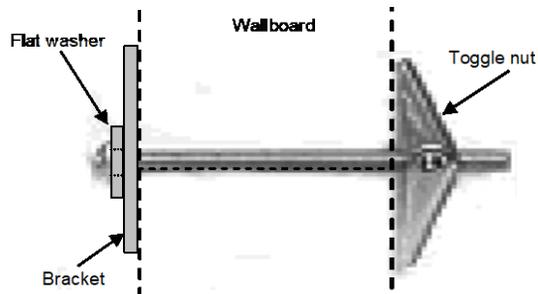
Installation sur panneau de revêtement ou placoplâtre
